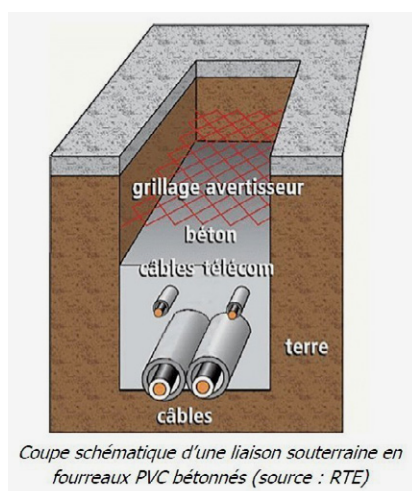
Coupe schématique d'une liaison souterraine en fourreaux PVC et exemple de travaux
